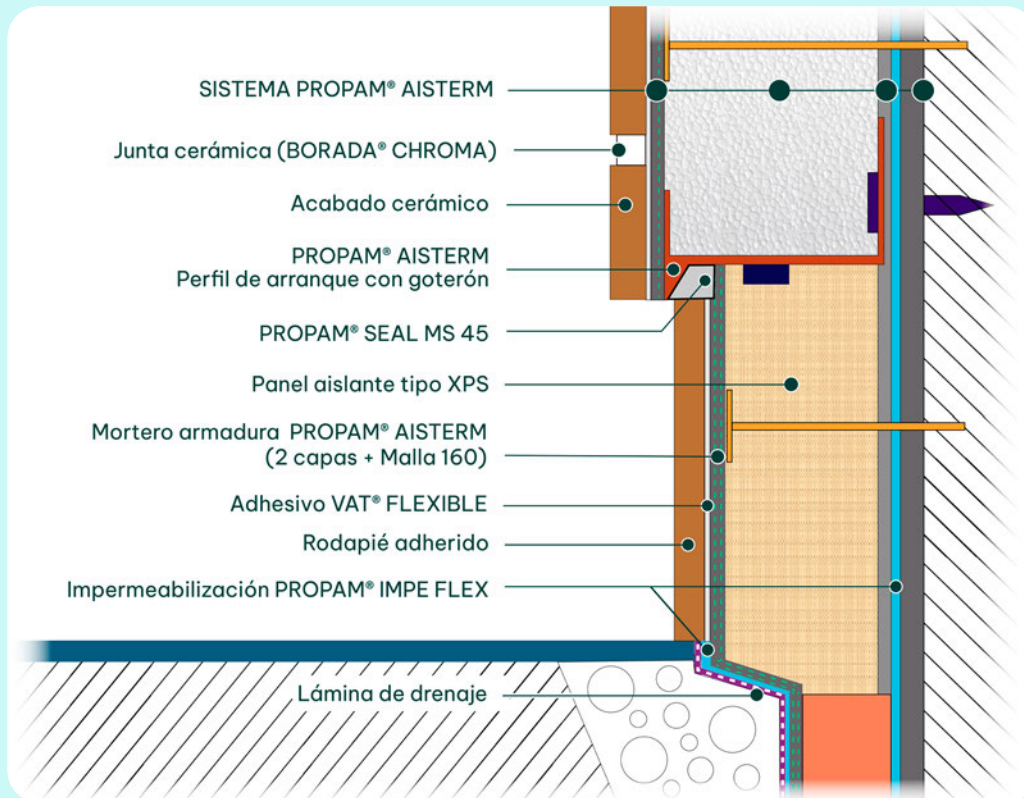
Esquema de un arranque enterrado con sistema de drenaje
